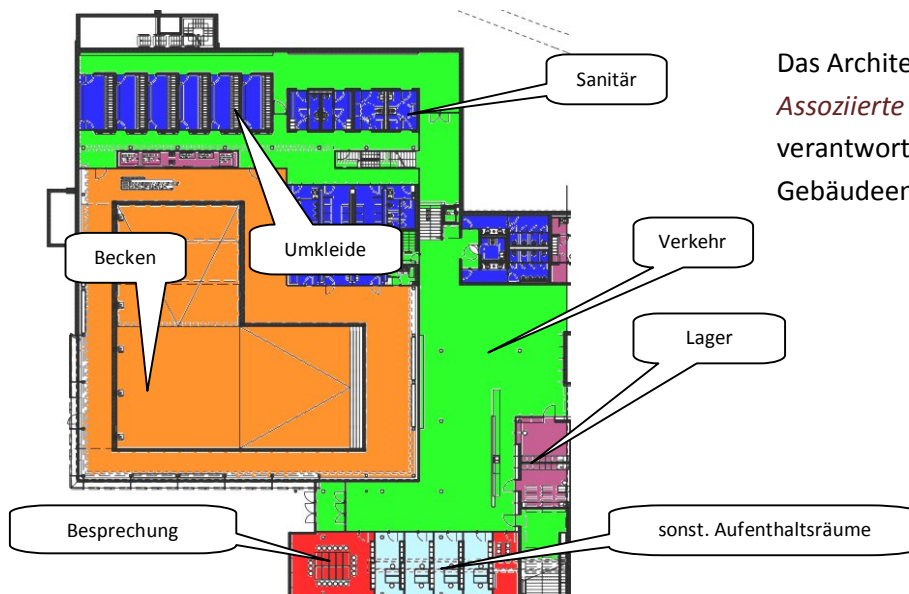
Grundriss Regelgeschoss mit Zonierung, Geb.11
